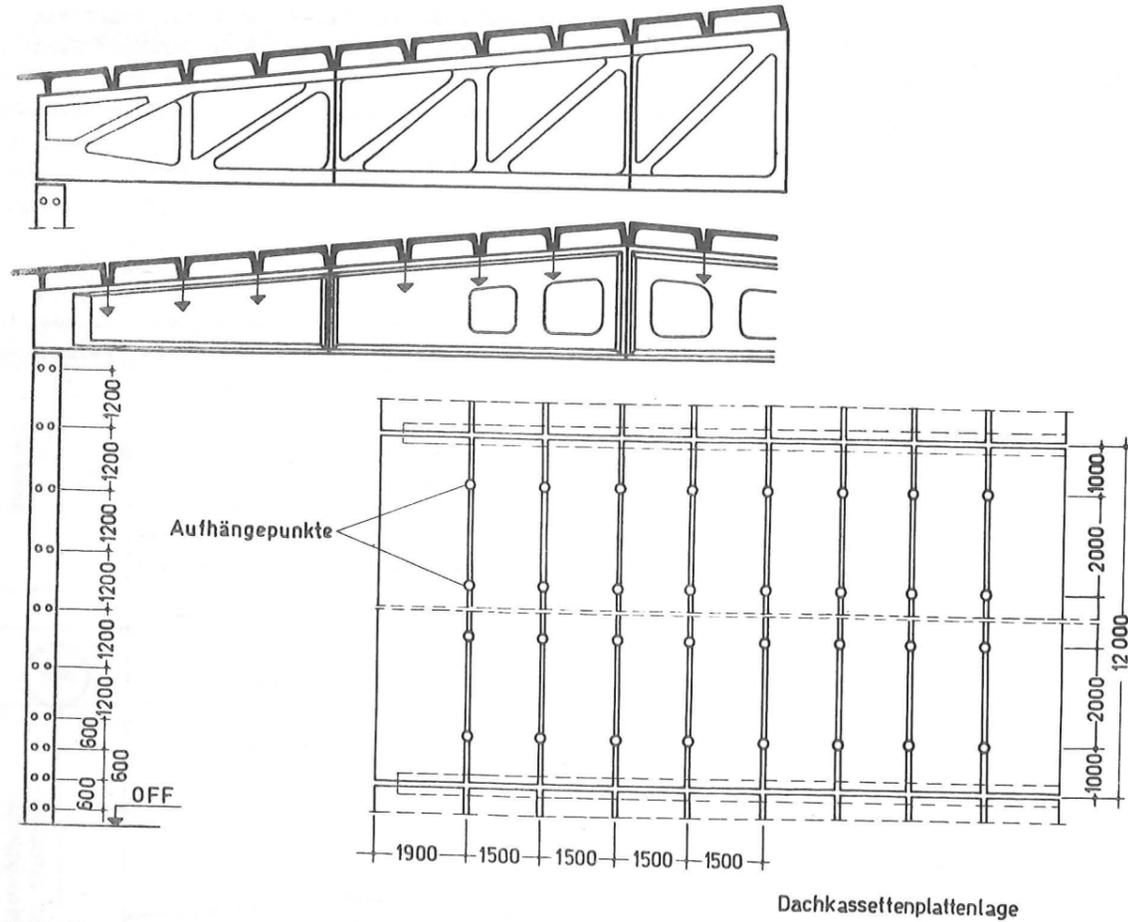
Anordnung von Ausrüstungen des versorgungstechnischen Ausbaues
